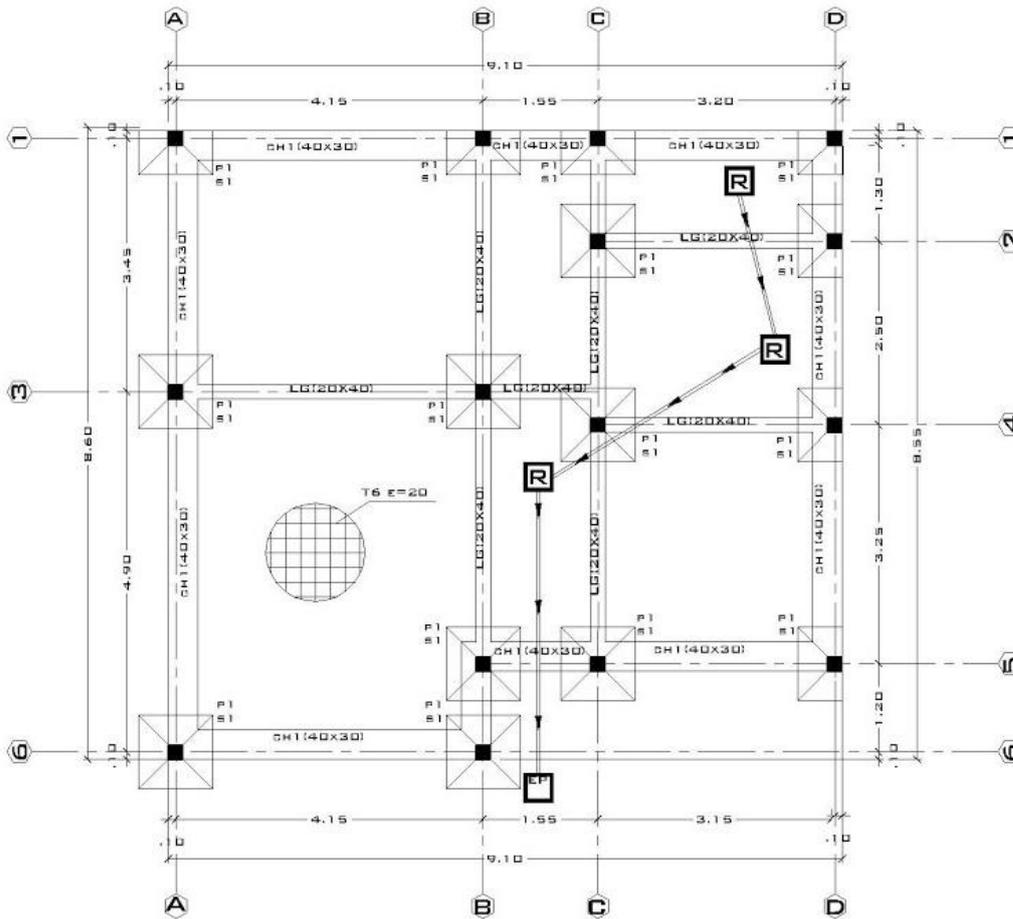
Exemple d'un plan des fondations isolés d'une maison d'habitation
